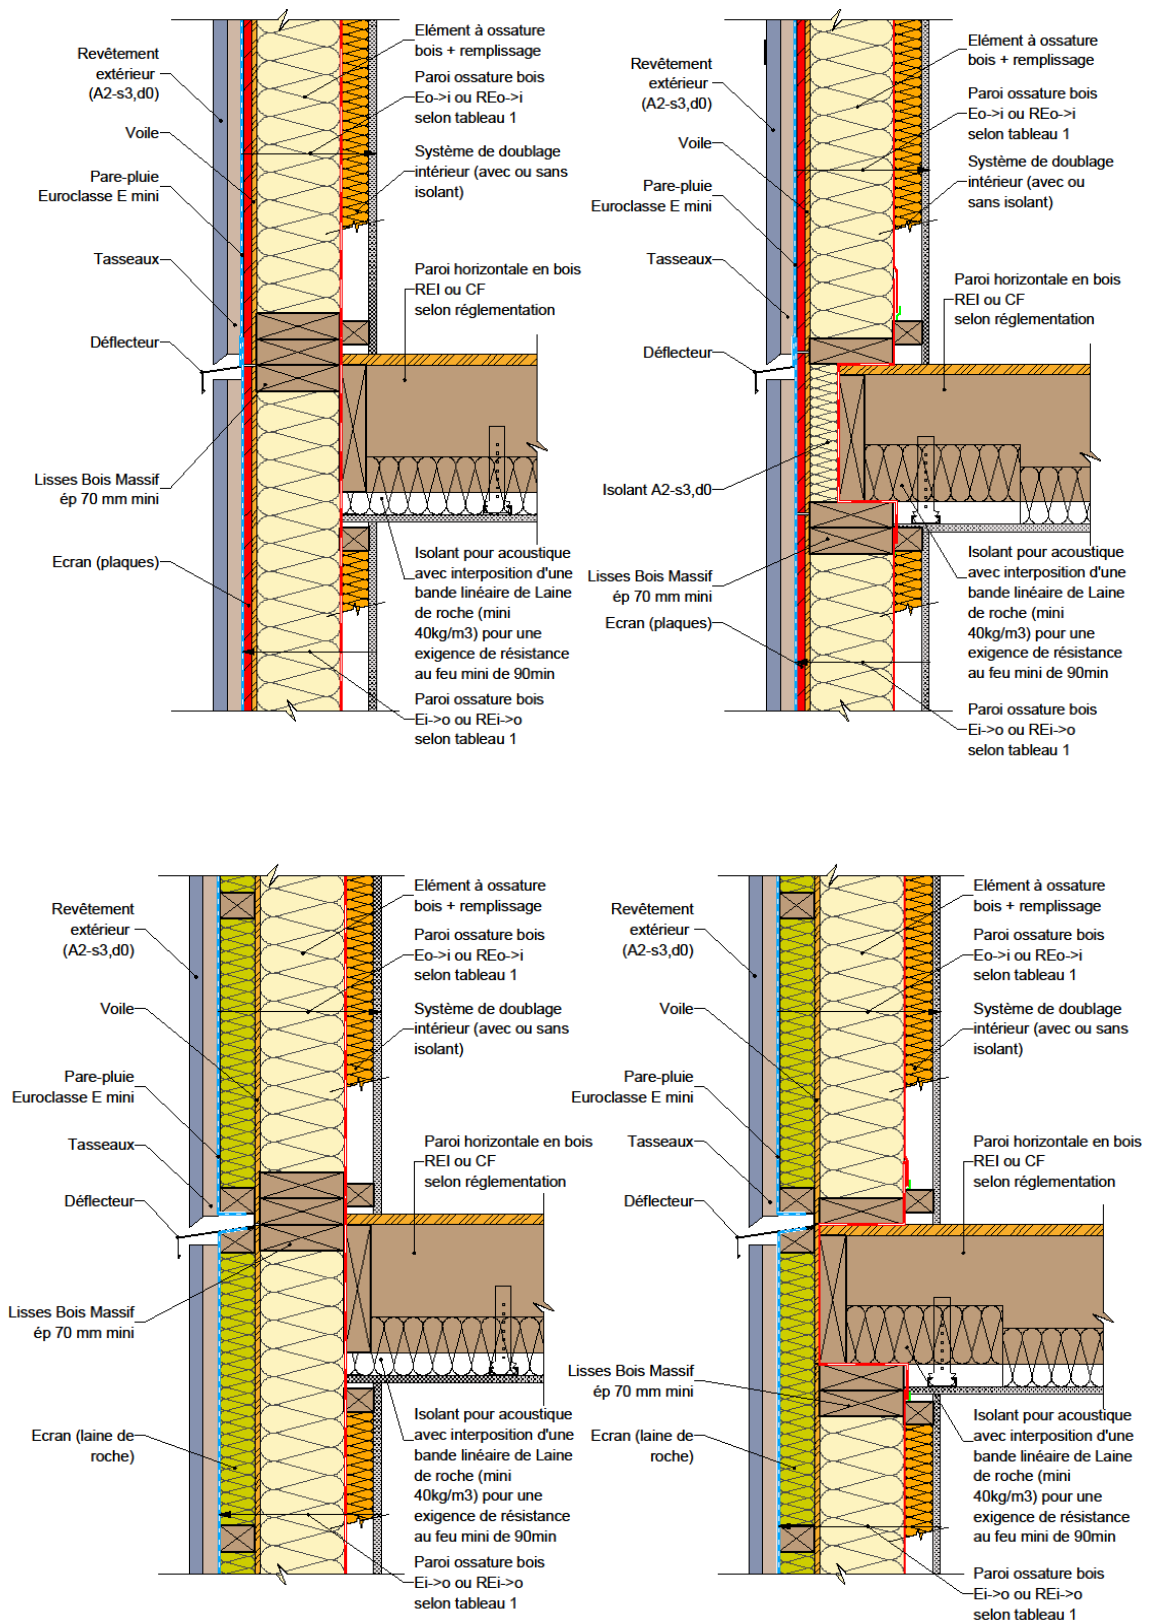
Façade/mur en ossature bois & plancher en ossature bois.
